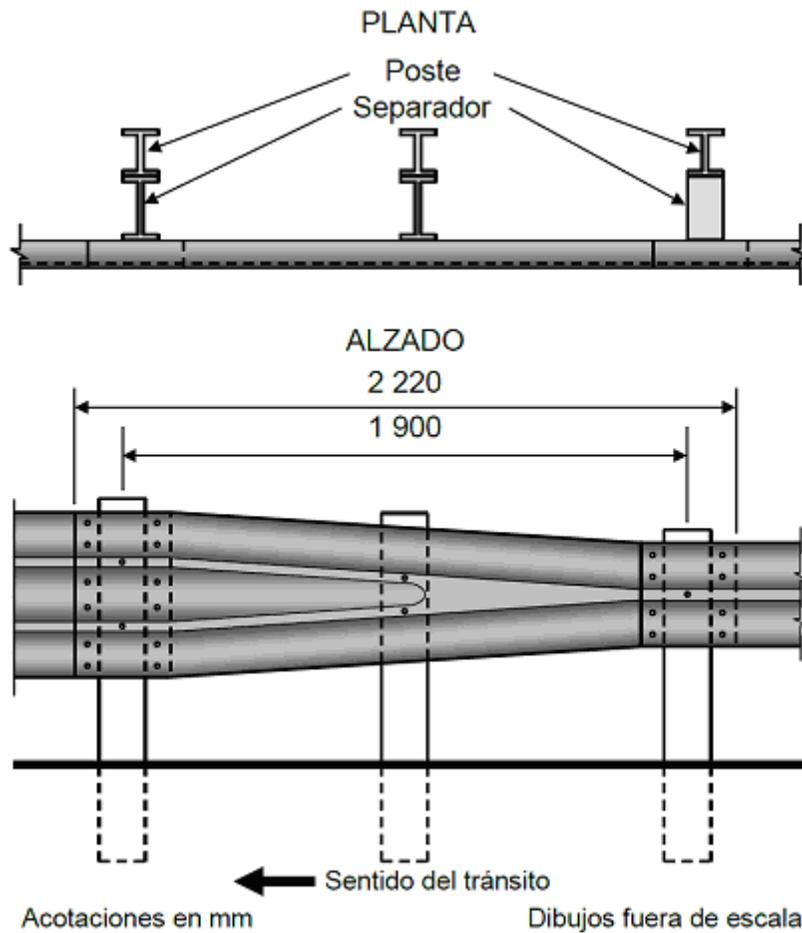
Sección de transición para unir vigas acanaladas de dos y de tres crestas
